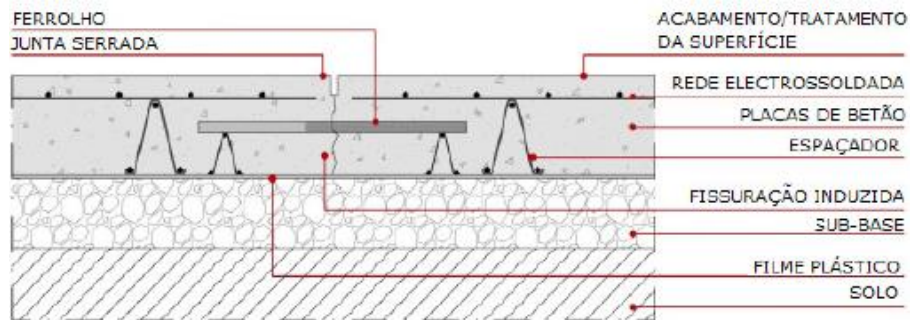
Pavimento reforçado com rede eletrossoldada (Passos, 2011)
